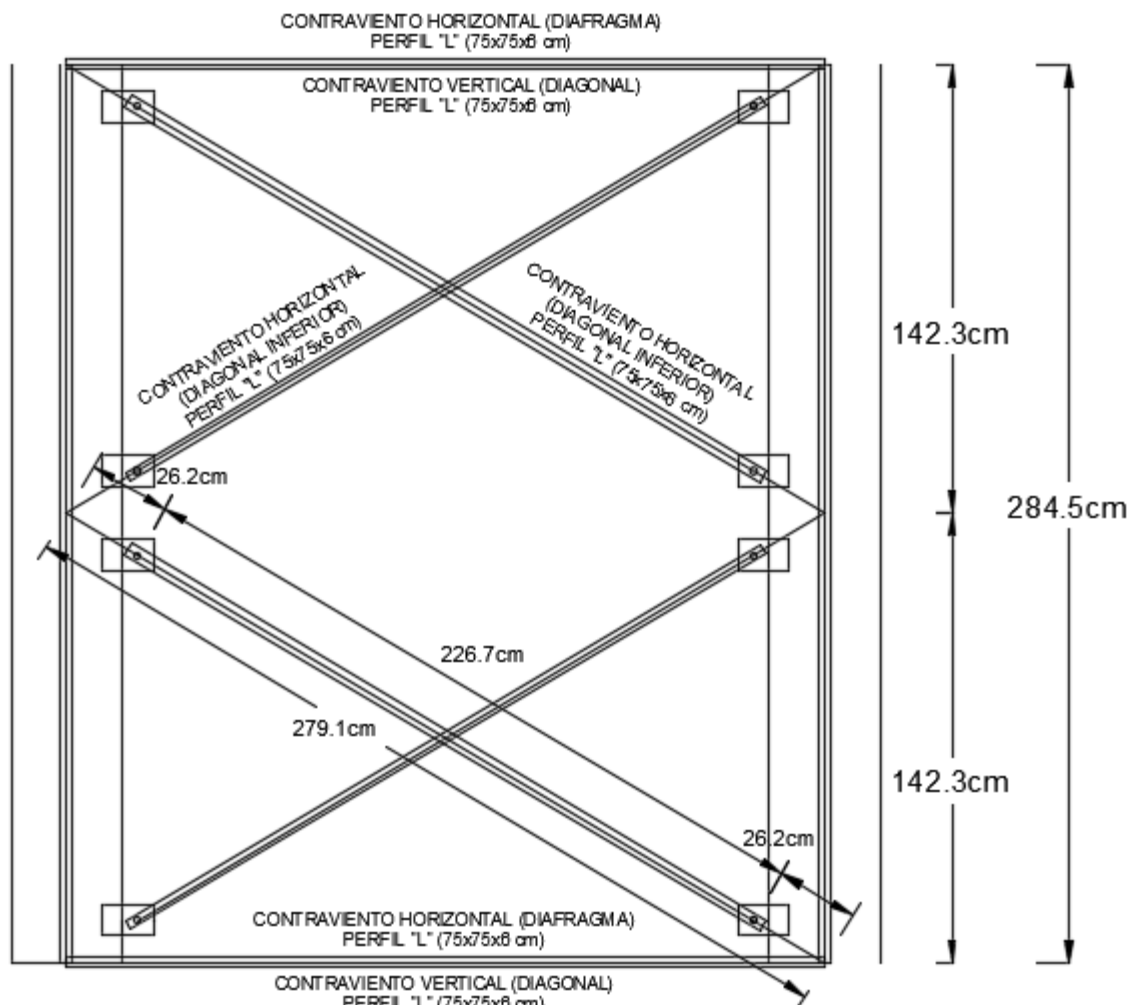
Contraviento horizontal (diagonal inferior). Realizado por: Autor
